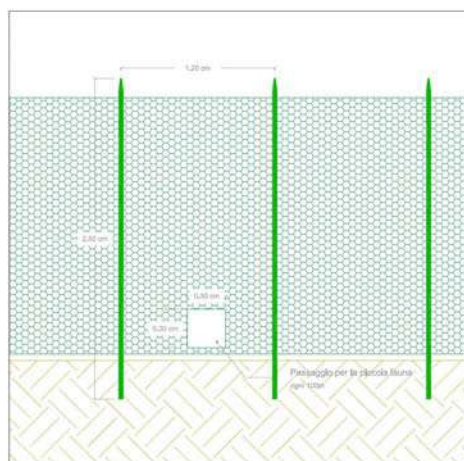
Particolare recinzione passaggio piccola fauna
